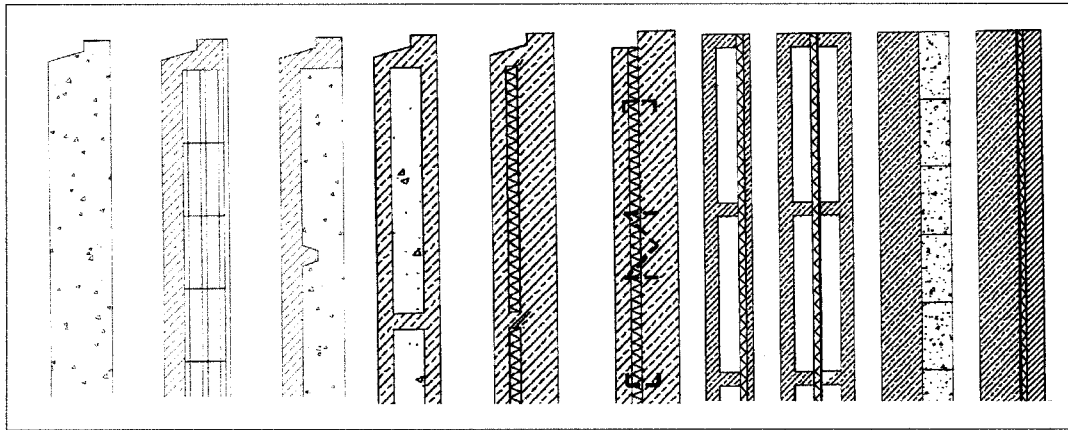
Betonarme Prefabrike Yapım Sistemleri Cephe Kuruluşlarında Uygulanabilen Beton Blok Elemanlar (Allen, 1999, s.298)
